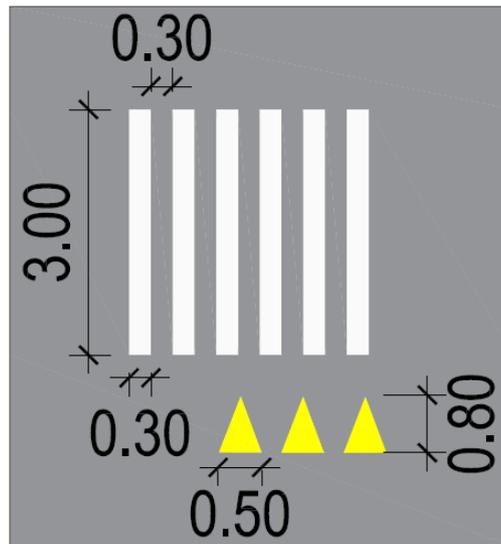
Planta esquemática com as cores e dimensões da sinalização horizontal das faixas elevadas
